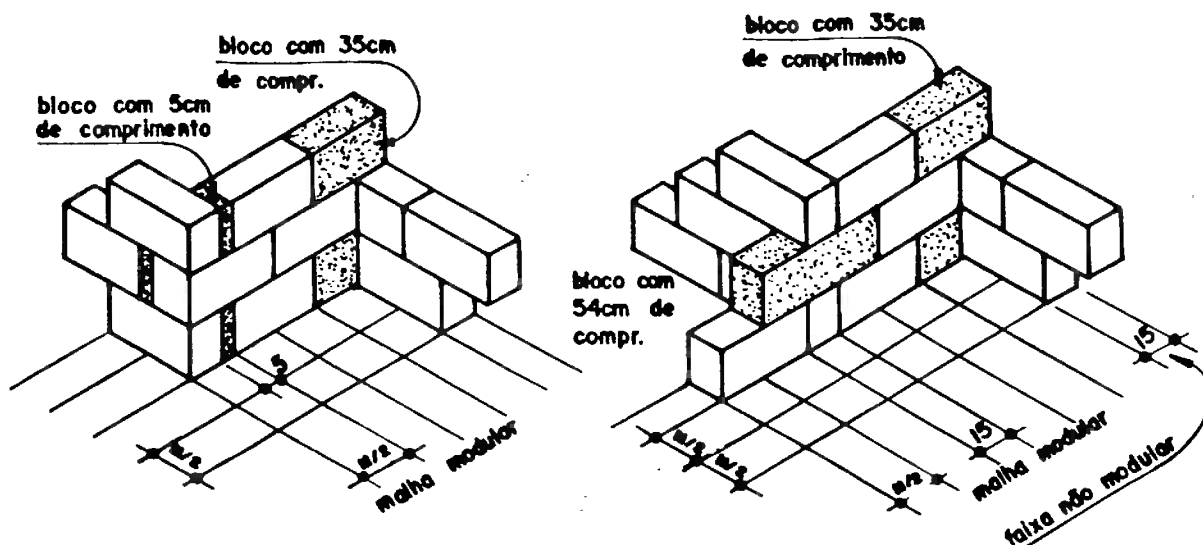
Amarração entre painéis de alvenaria: (a) amarração de canto de "meio bloco"; (b) amarração "de terço".
